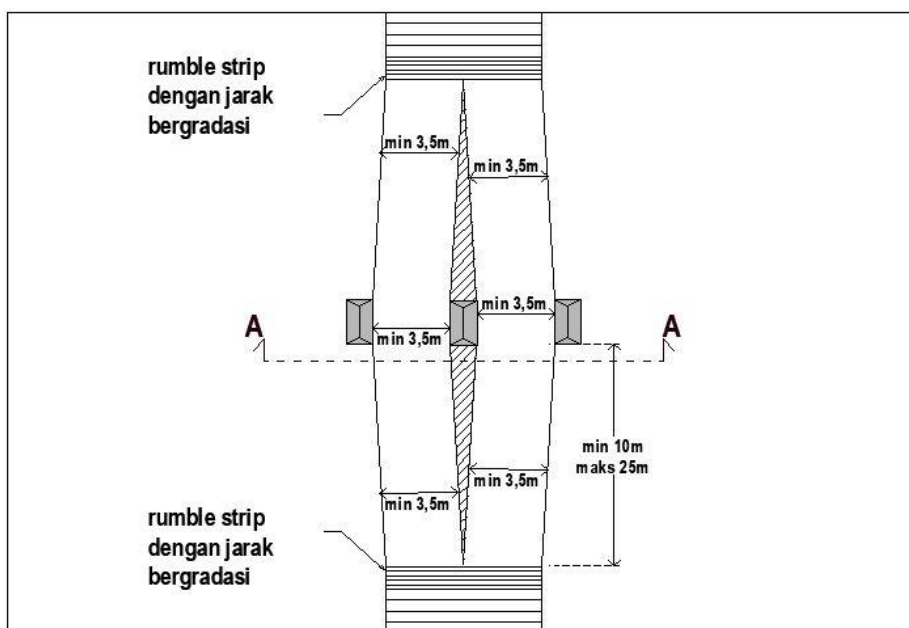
Contoh Ruang Milik Jalan Tipe 5
